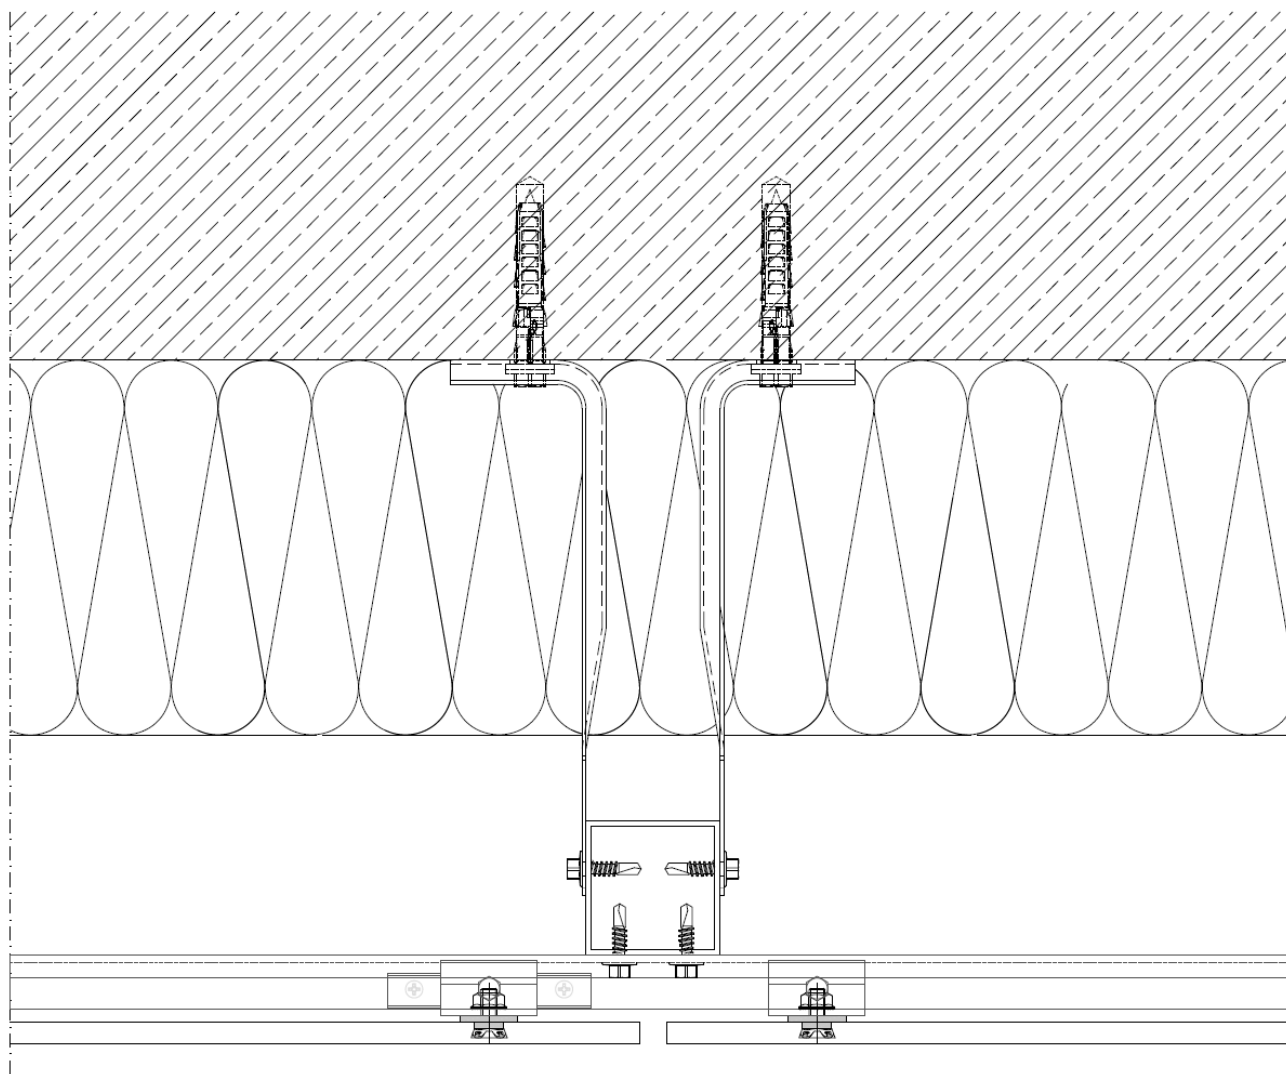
Horizontaler Schnitt mit vertikalem Kastenprofil, ATK 103 Unterkonstruktion und FZP II Hinterschnittanker für nicht sichtbar befestigte Fassadenplatten.
